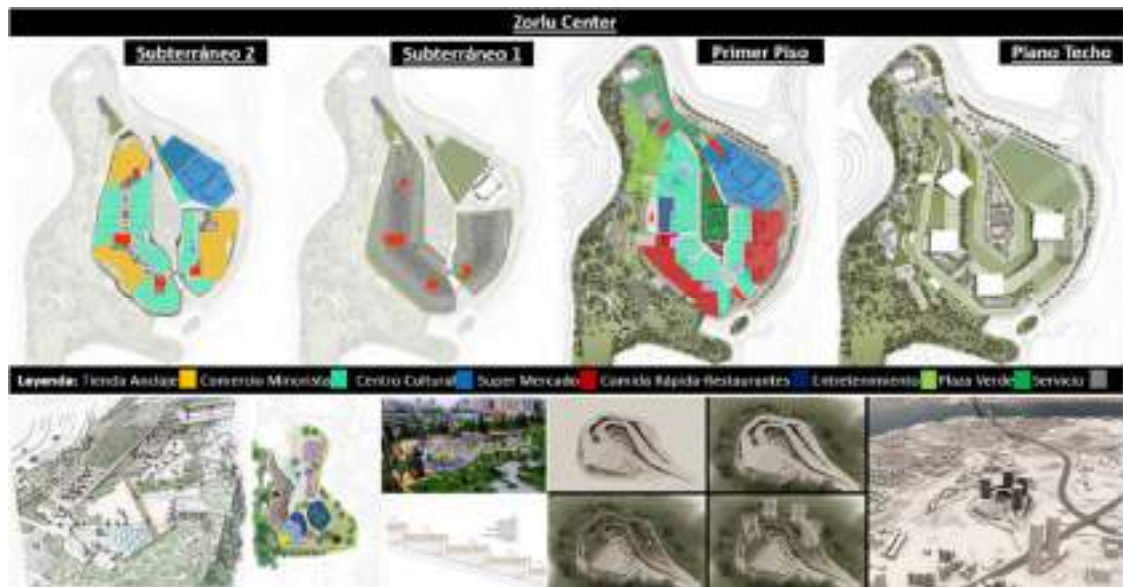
Planimetría de planos de planta, boceto, diseño de parque de entretenimiento y visuales 3D.
